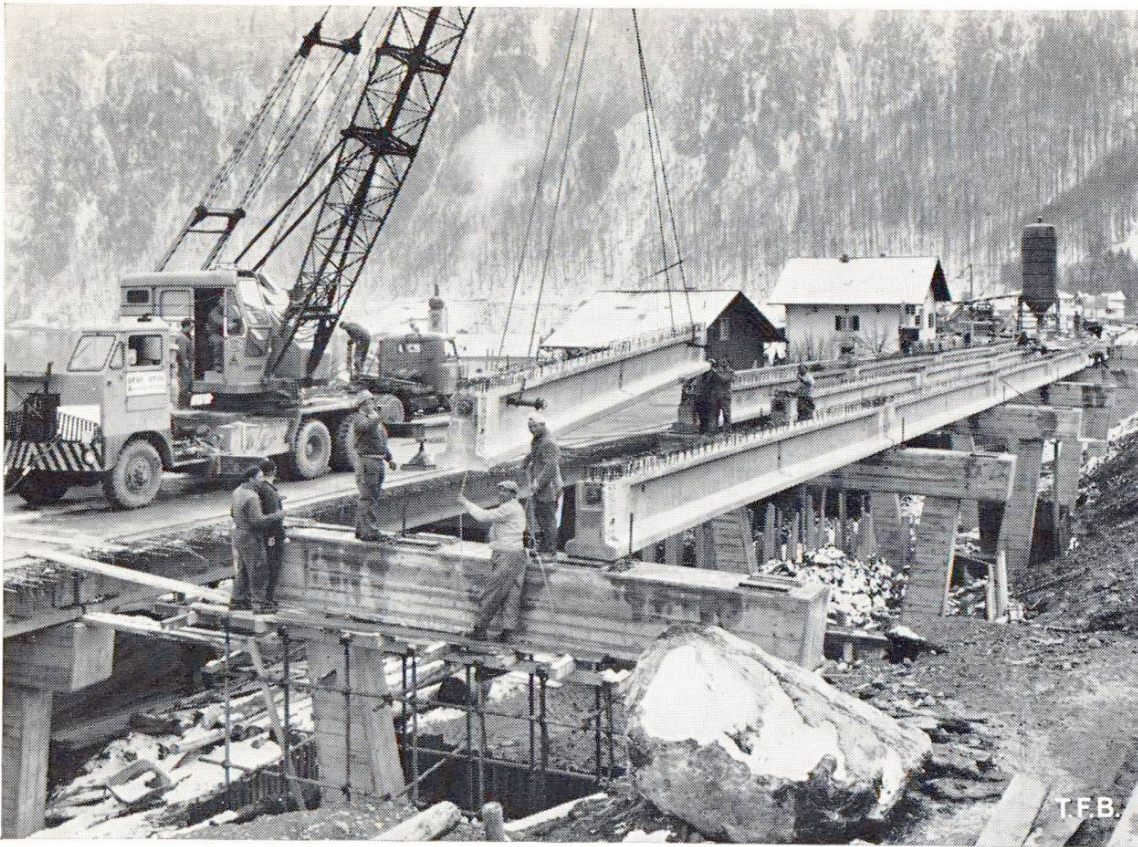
Pont d'autoroute à Hergiswil, avec poutres en béton de 13,7 m, préfabriquées et précontraintes. Les quatre poutres d'une travée sont reliées entre elles par trois traverses, bétonnées sur place et précontraintes. Palées et dalle chaussée sont également bétonnées sur place. Projet: O. J. Seiler, ing. dipl., Hergiswil. Précontrainte: Stahlton AG, Zurich.
